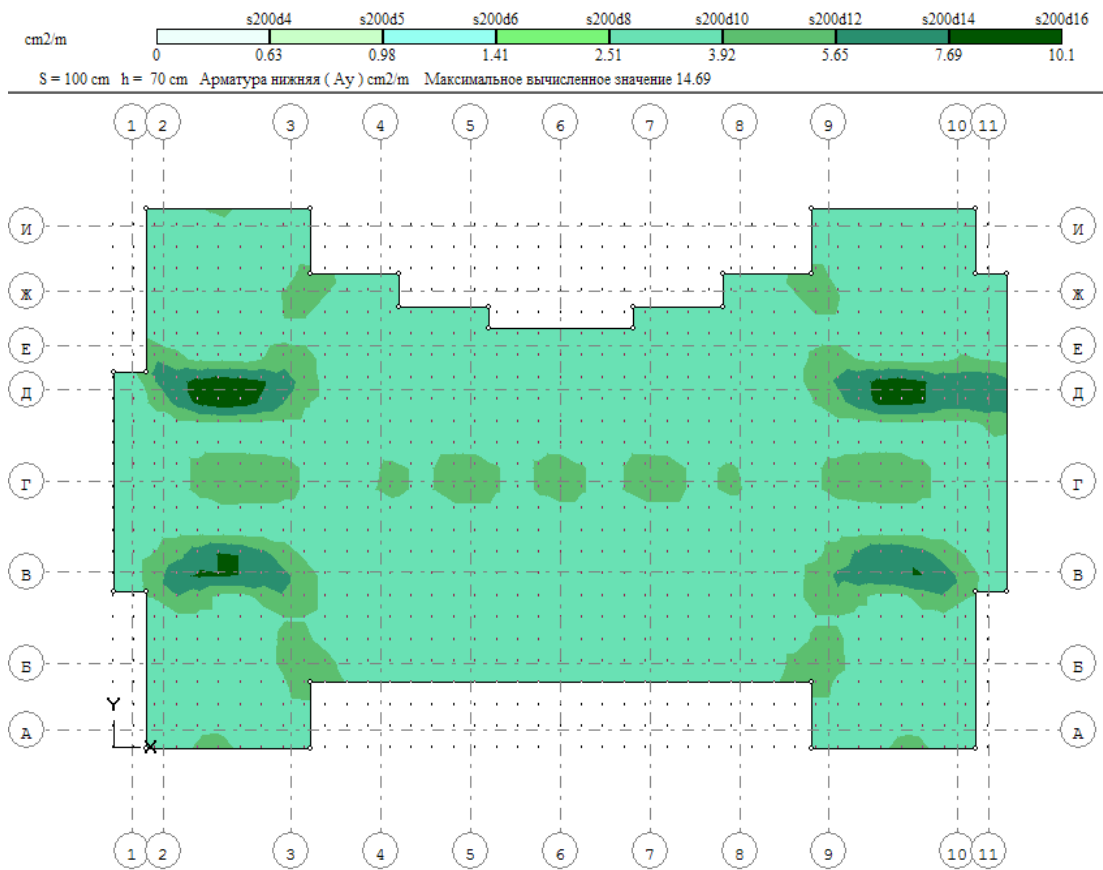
Мозаика армування плити по осі Y нижній пояс (до реконструкції)
